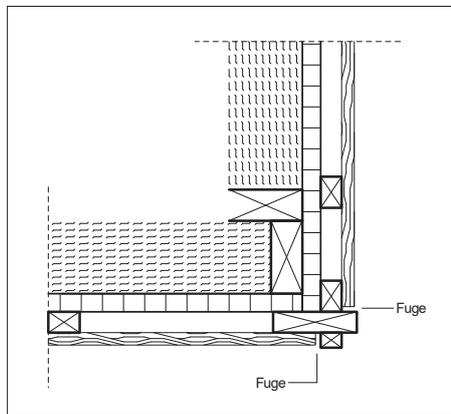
Fassadenecke bei Profilschalung mit Holzleisten. Der Abstand der unbeschichteten Fassadenbretter zu den Eckleisten beträgt 10 mm. Durch die Luffugen wird das Auslüften (Austrocknen) ermöglicht.
